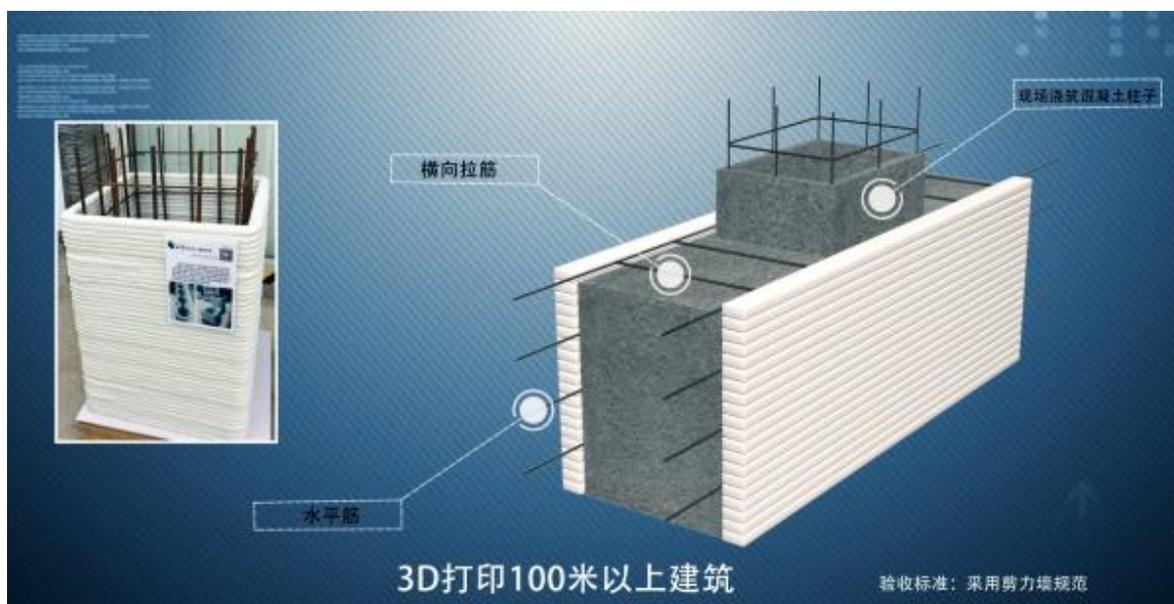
Estándar de construcción para edificios de más de 100 metros de altura
